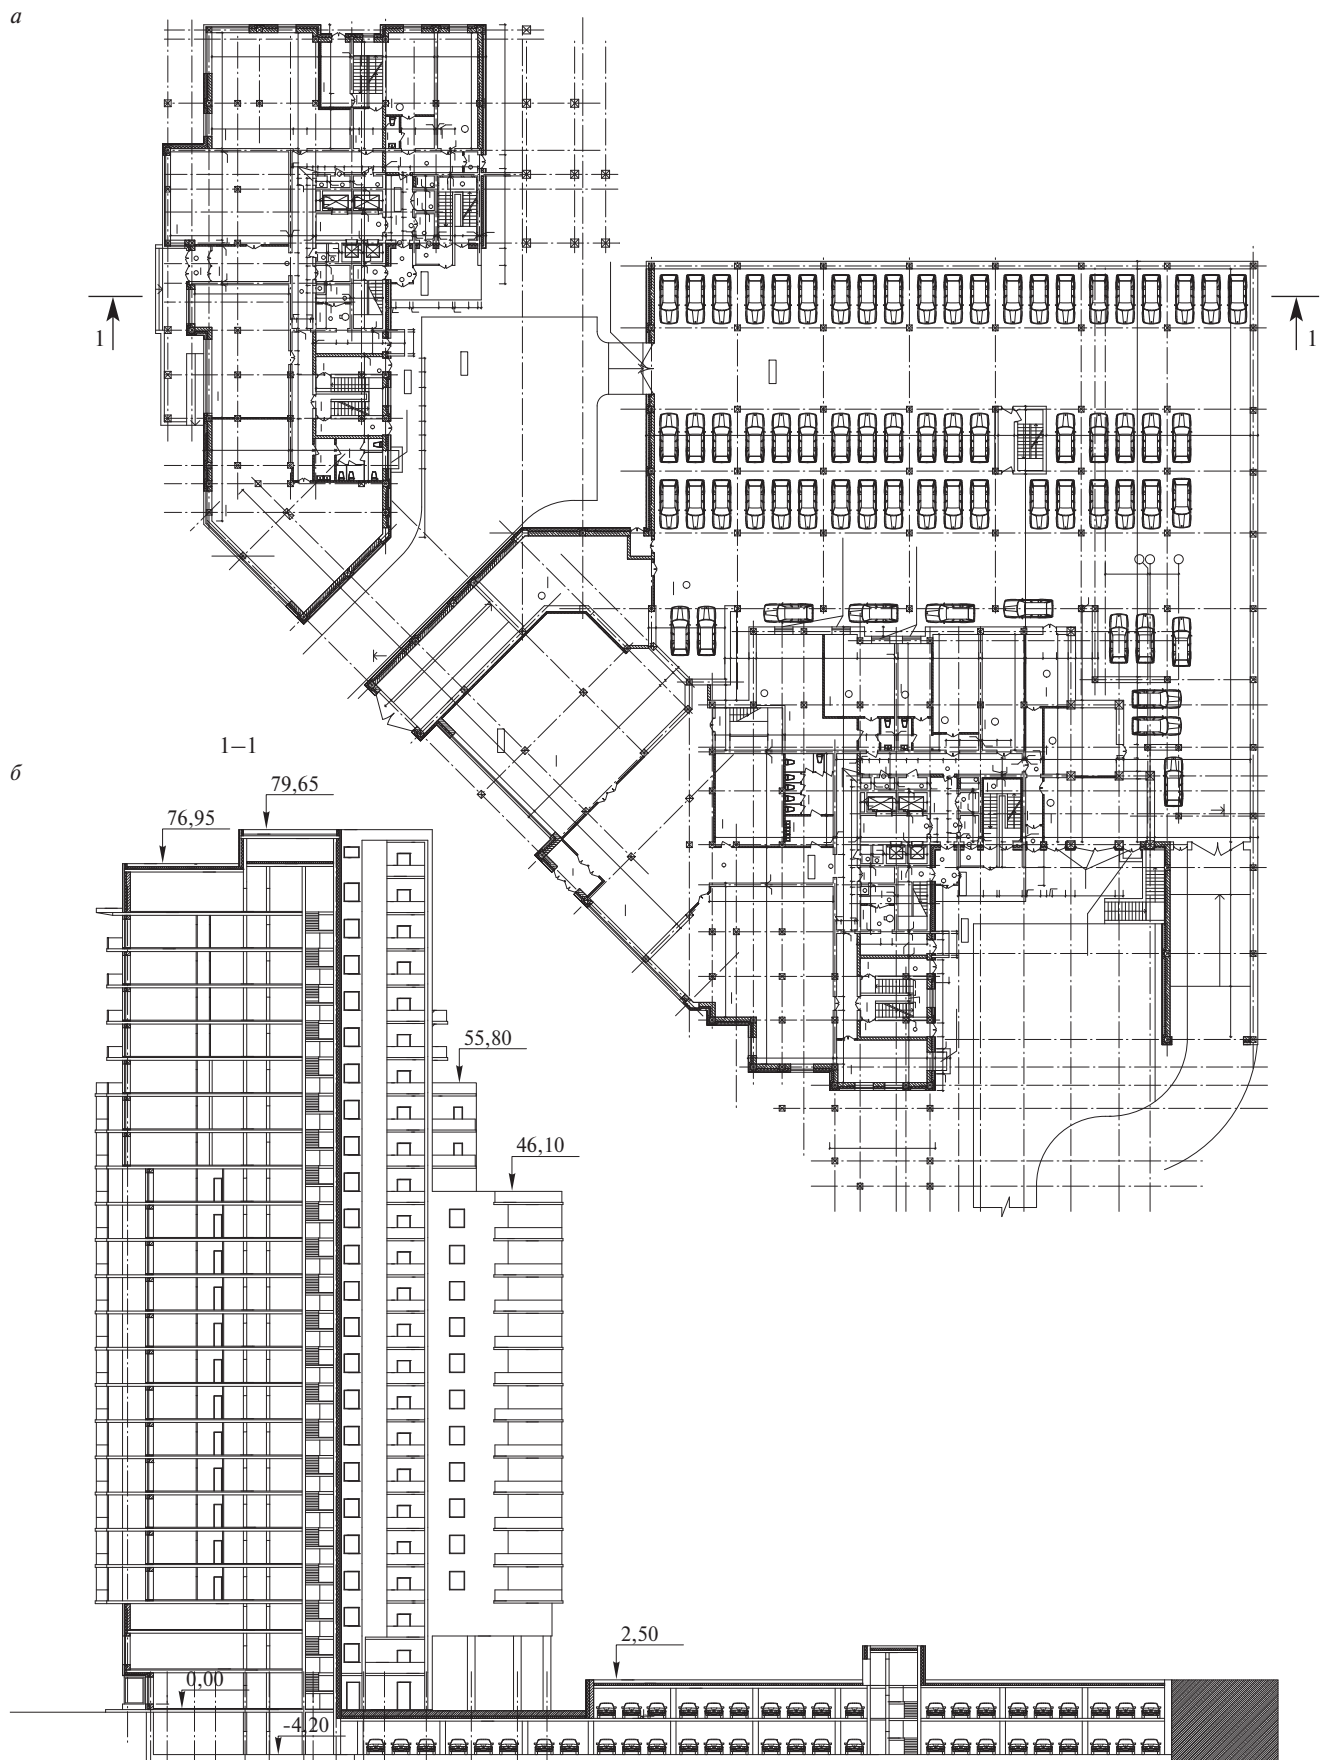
План жилого комплекса «Richeville»: а – план на отм. 0.00; б – разрез 1-1
